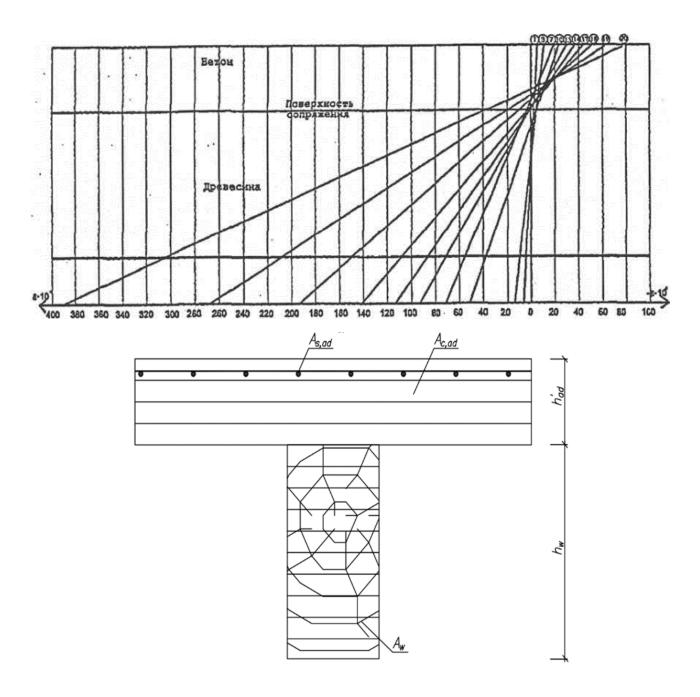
Распределение деформаций по высоте поперечного сечения несущей балки фрагмента дерево-железобетонного перекрытия при разных уровнях нагружения в зоне максимального изгибающего момента
